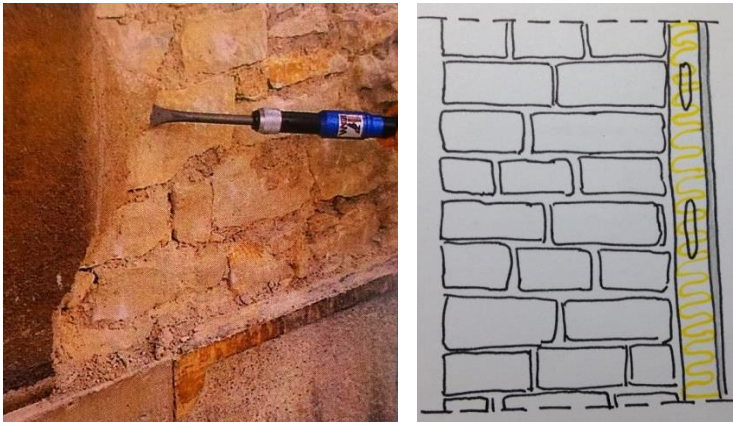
Fachada con mampuestos visto y detalle de trasdosado. Fuente: Autor.
